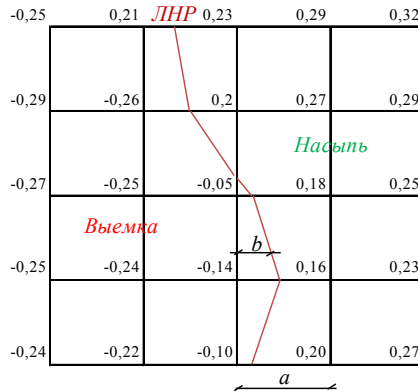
План строительной площадки с рабочими отметками и линией нулевых работ, разделяющей зону выемки и зону насыпи
